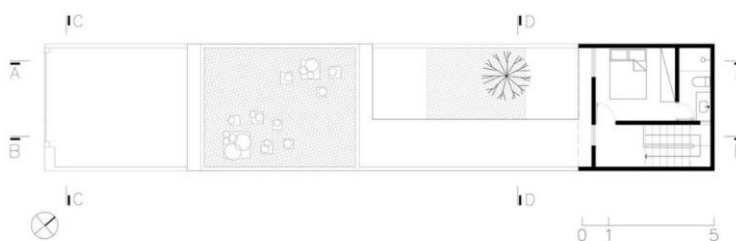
Planta Baixa parte T rrea da Casa Vila Matilde.
